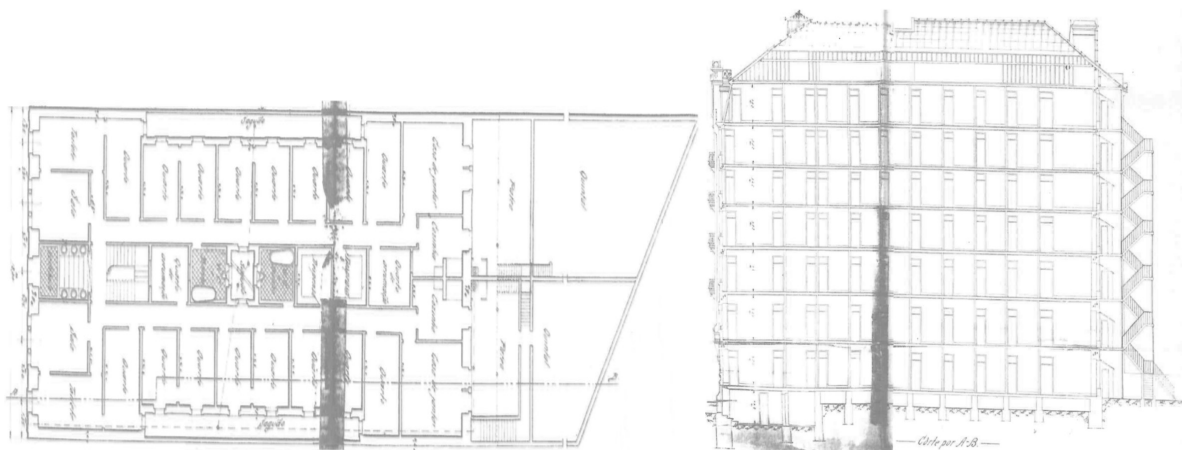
Planta e corte tipo de um edifício Gaioleiro (Rodrigues, 2001).
